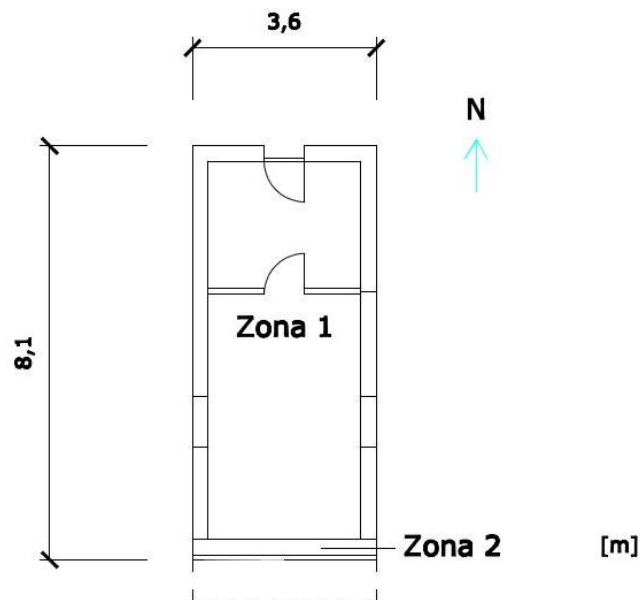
Planta do edifício para o caso da utilização da parede Trombe
